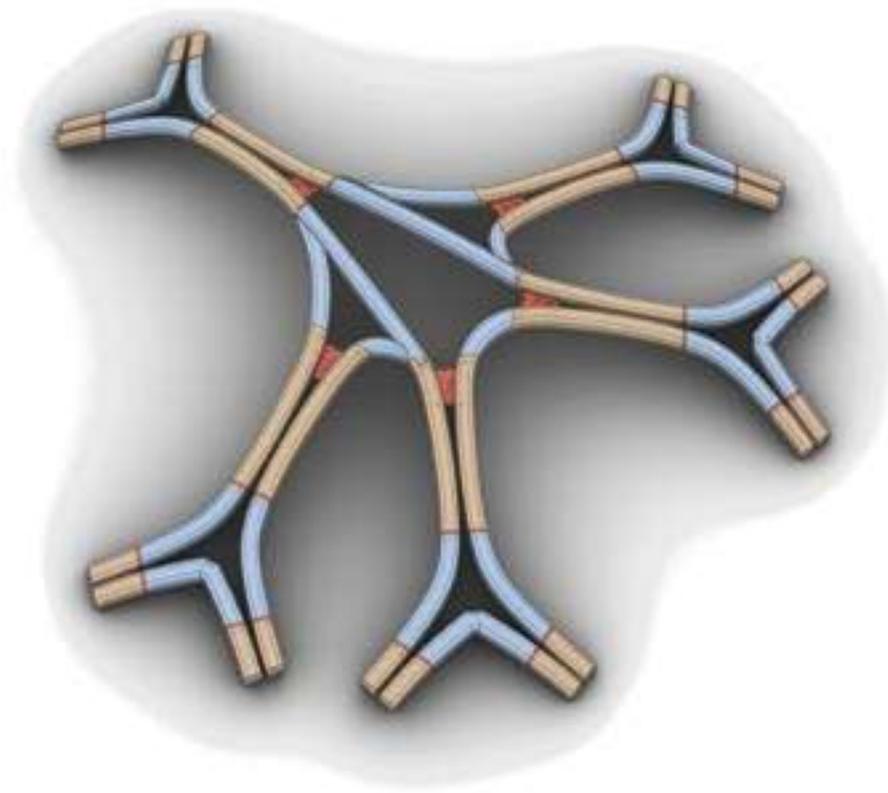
Voronoi Fassade - Detail Verbindungen
